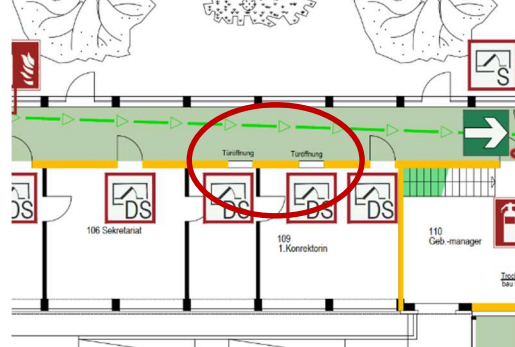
Planausschnitt Erdgeschoss (Brandschutzkonzept vom 02.11.22)
